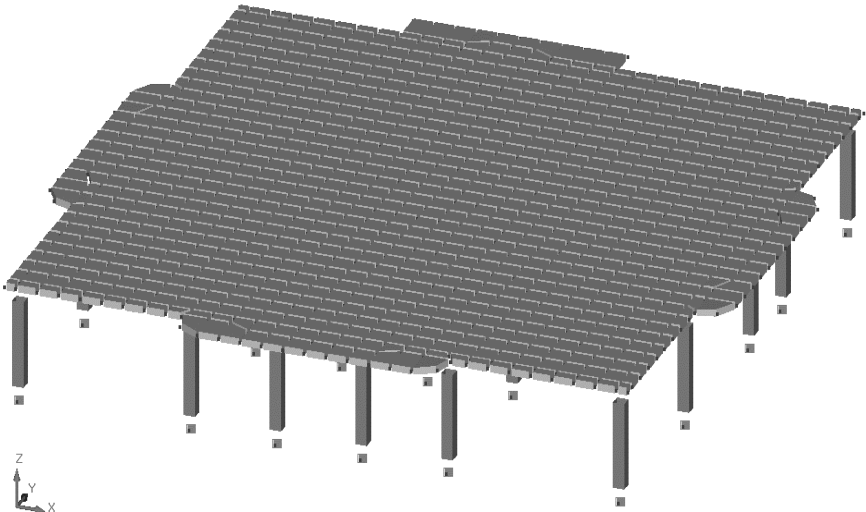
Модель першого поверху будівлі в ПК SCAD Office
